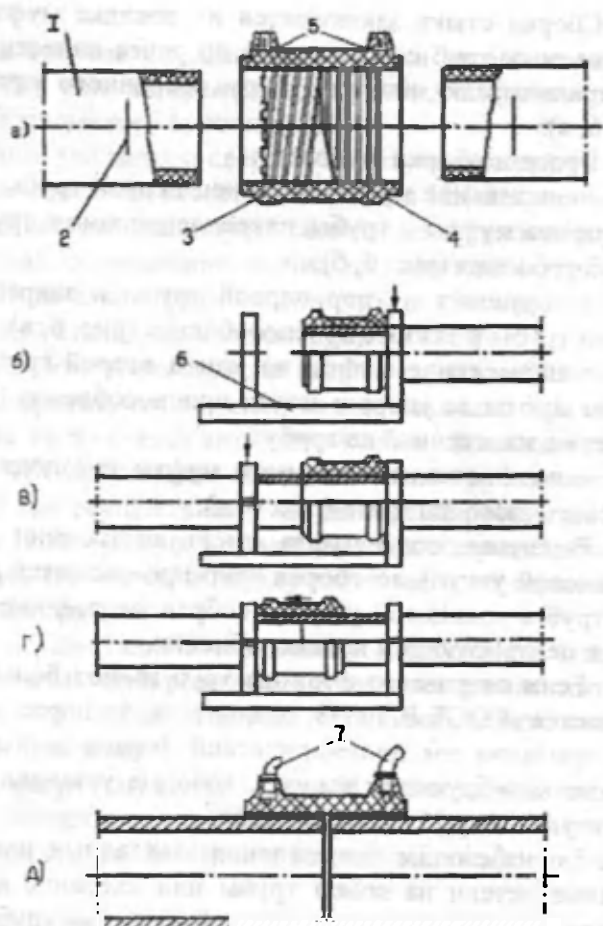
Схема соединения труб муфтой с закладным нагревателем: а -- подготовка соединяемых элементов; б, в, г -- этапы сборки стыка; д -- собранный под сварку стык; 1 -- труба; 2 -- метка посадки муфты и механической обработки поверхности трубы; 3 -- муфта; 4 -- закладной нагреватель; 5 -- клеммы токопровода; 6 -- приспособление для сборки; 7 -- токопроводящие кабели сварочного аппарата
